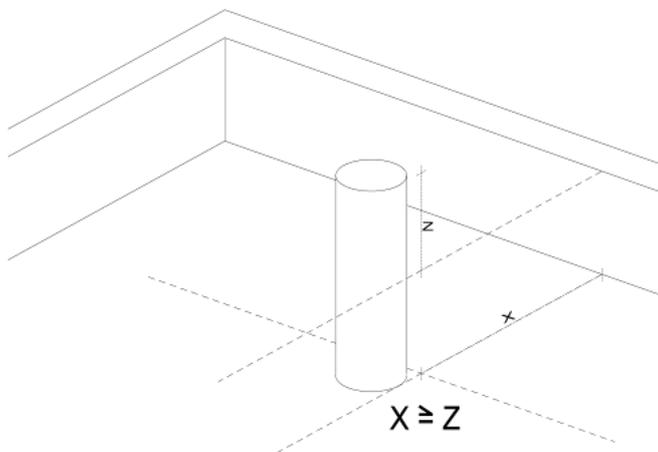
Beispielskizze Mindestabstand der Dachaufbauten auf Flachdächern zu Außenfassaden, Quelle: SCHÖFFLER.stadtplaner.architekten.
